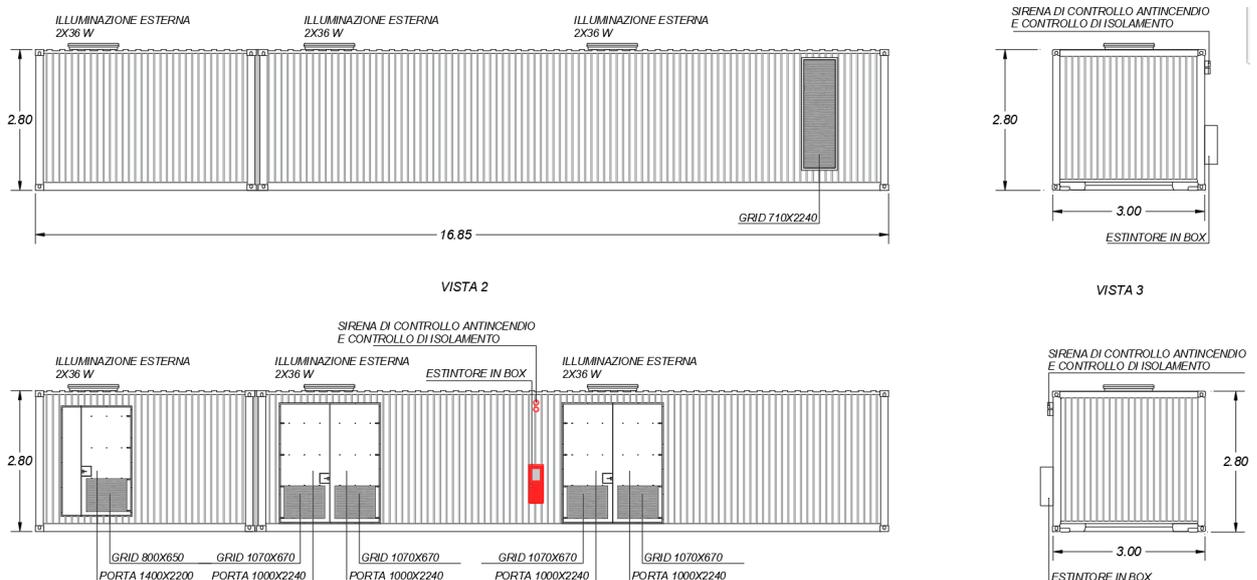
Planimetria cabina generale AT - prospetti frontale e del retro
